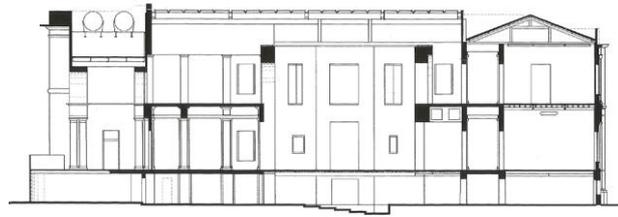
Corte transversal da Pinacoteca do Estado de São Paulo.
